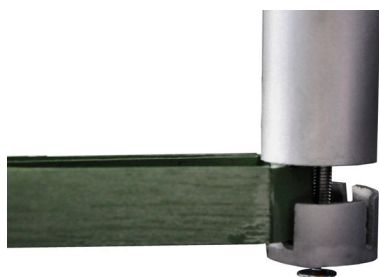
Maqueta de sistema de pavimento sobrelevado para espaço de exposição. Pormenor do nivelador. Registo de Salomé Arieira.
